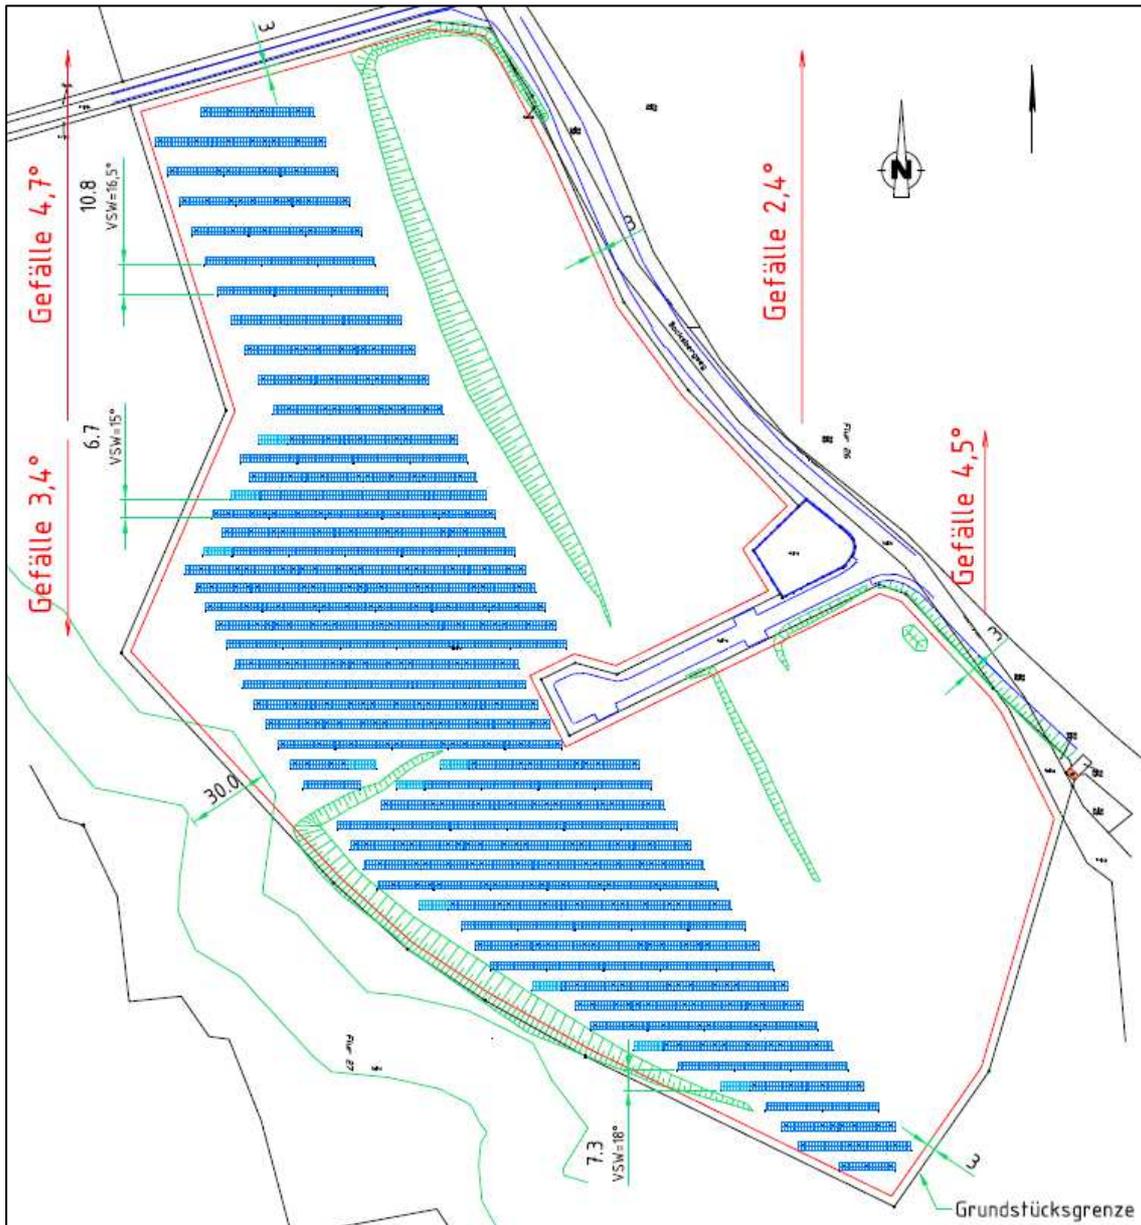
Entwurf für den Belegungsplan. Quelle: KÜHLING GmbH 25.09.2013. Module: blau, Relief: grün, und rot umrandet: Grundstücksgrenze. Bereich mit Modulen = Änderungsbereich des B-Plans-Nr. 17.3
